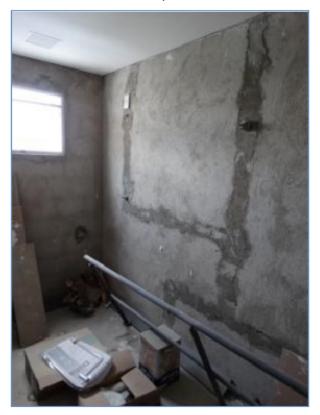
2º pavimento - Banheiro suíte inacabado
